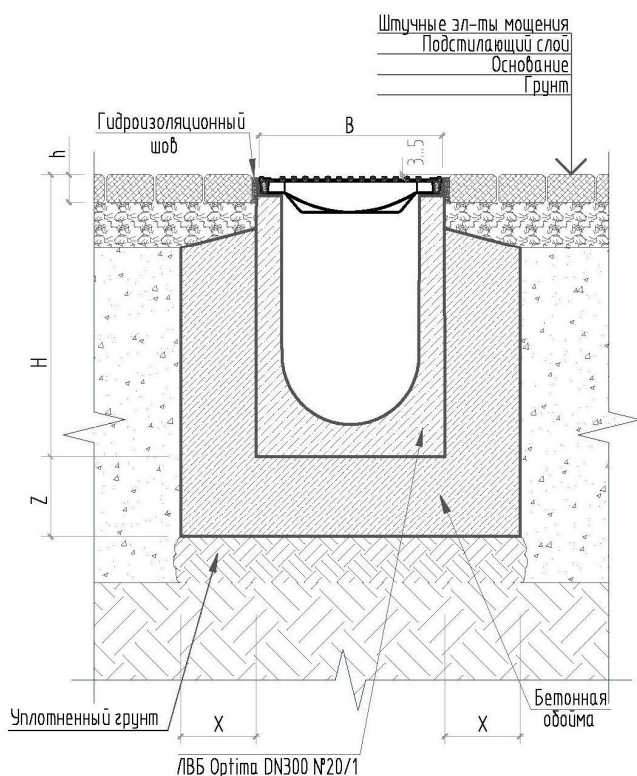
а – Устройство упрощенной бетонной обоймы лотка с штучными элементами мощения для классов нагрузки от А15 до В150.
